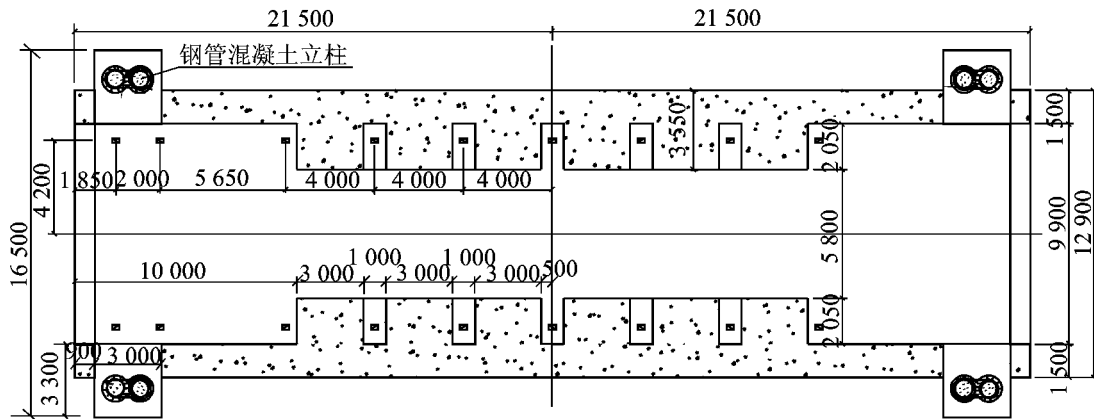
预埋吊带及钢管混凝土立柱布置图(单位:mm)
